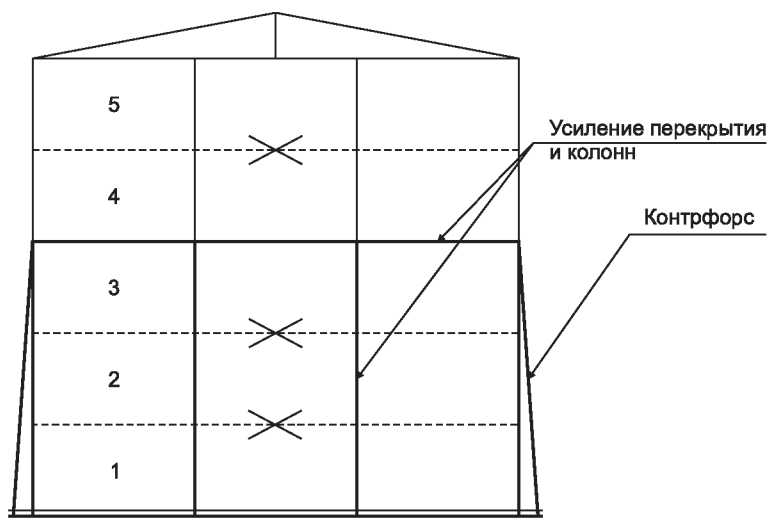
Схема реконструкции пятиэтажного здания под двухэтажный склад
